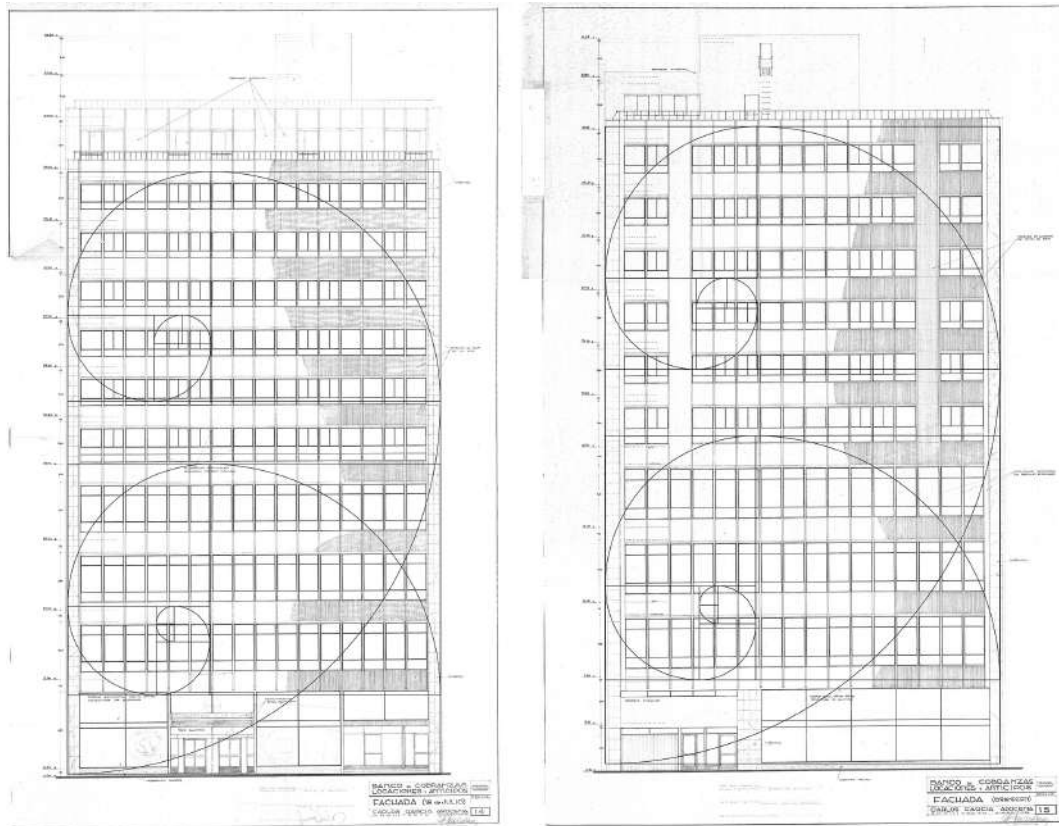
Trazado regulador aplicado a las fachadas del BCLA. Nótese el ajuste proporcionado del sector inferior, correspondiente al banco, y el del *falso muro cortina* hasta el nivel de gálibo.
